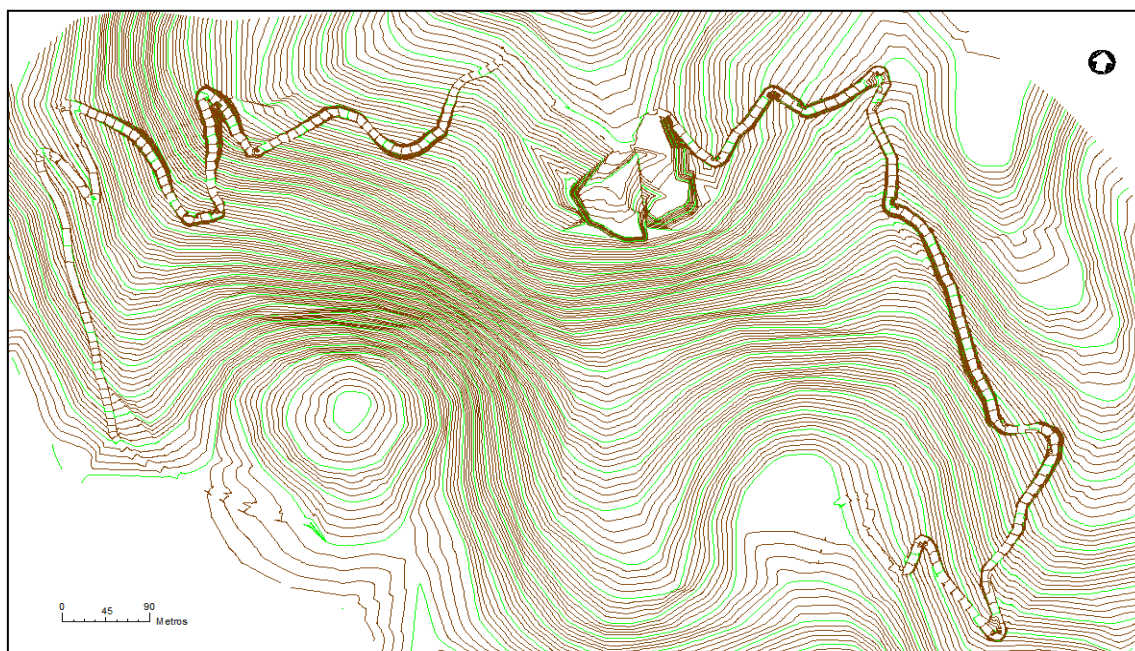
Topografía de la cantera con el emplazamiento de las vías y los niveles actuales 17 y 18 (vista de planta)
